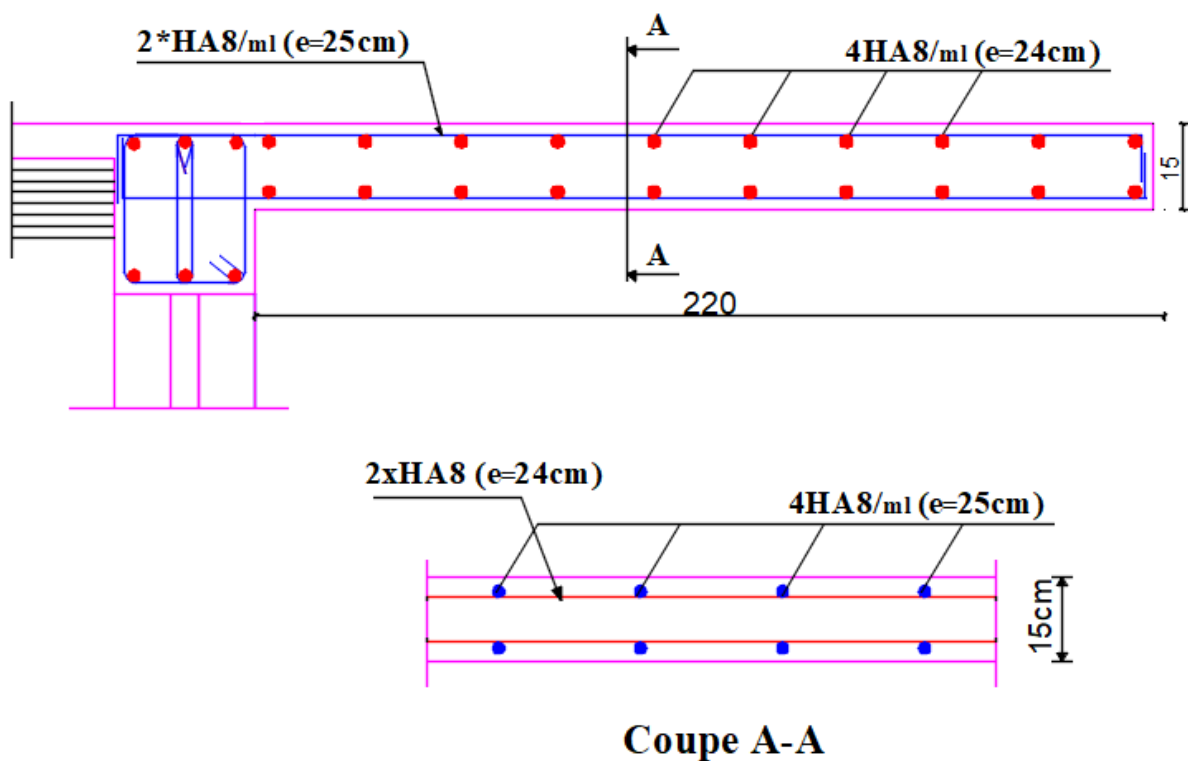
Schéma Ferrailage de la dalle pleine isolée.
